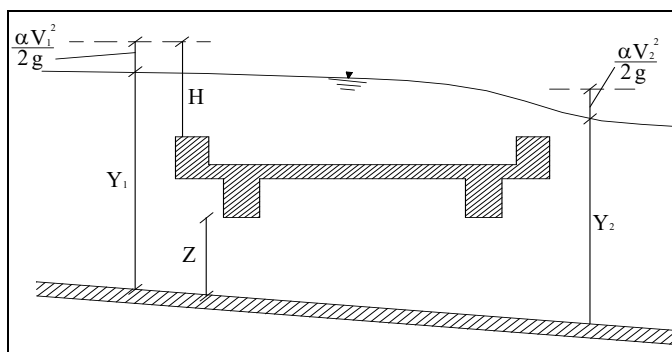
Sezione schematica di un ponte – Schema di calcolo
